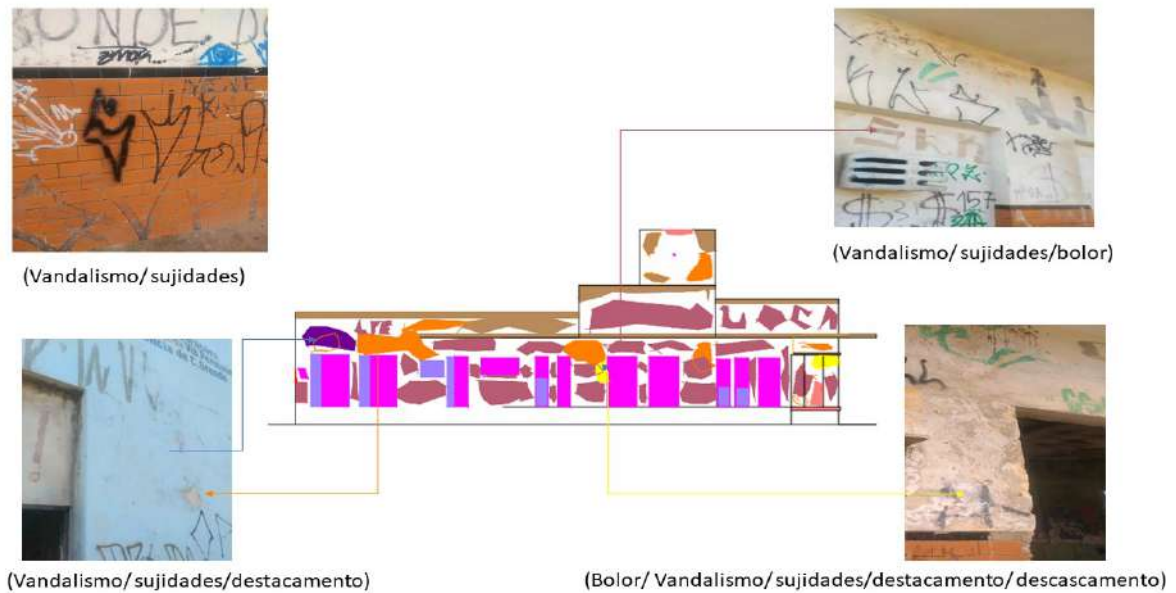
Fachada oeste Fonte: acervo próprio (2021)
